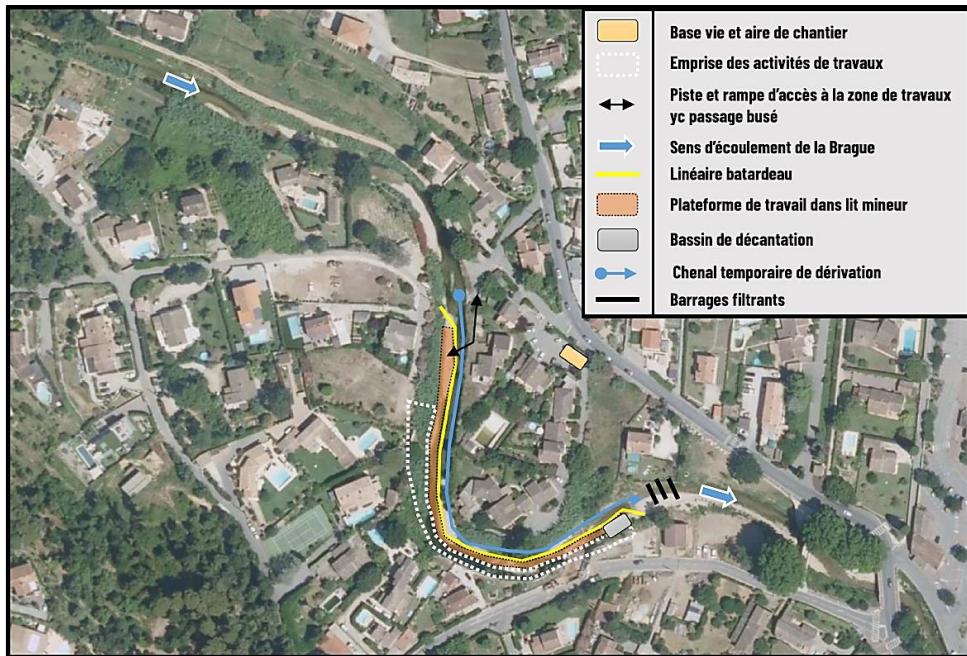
Plan des installations de chantier dans le cadre du confortement de la berge rive droite
